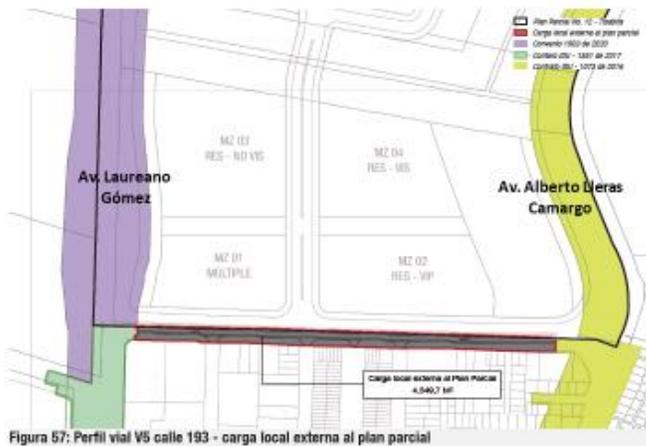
Perfil vial V5 calle 193 - carga local externa al plan parcial
